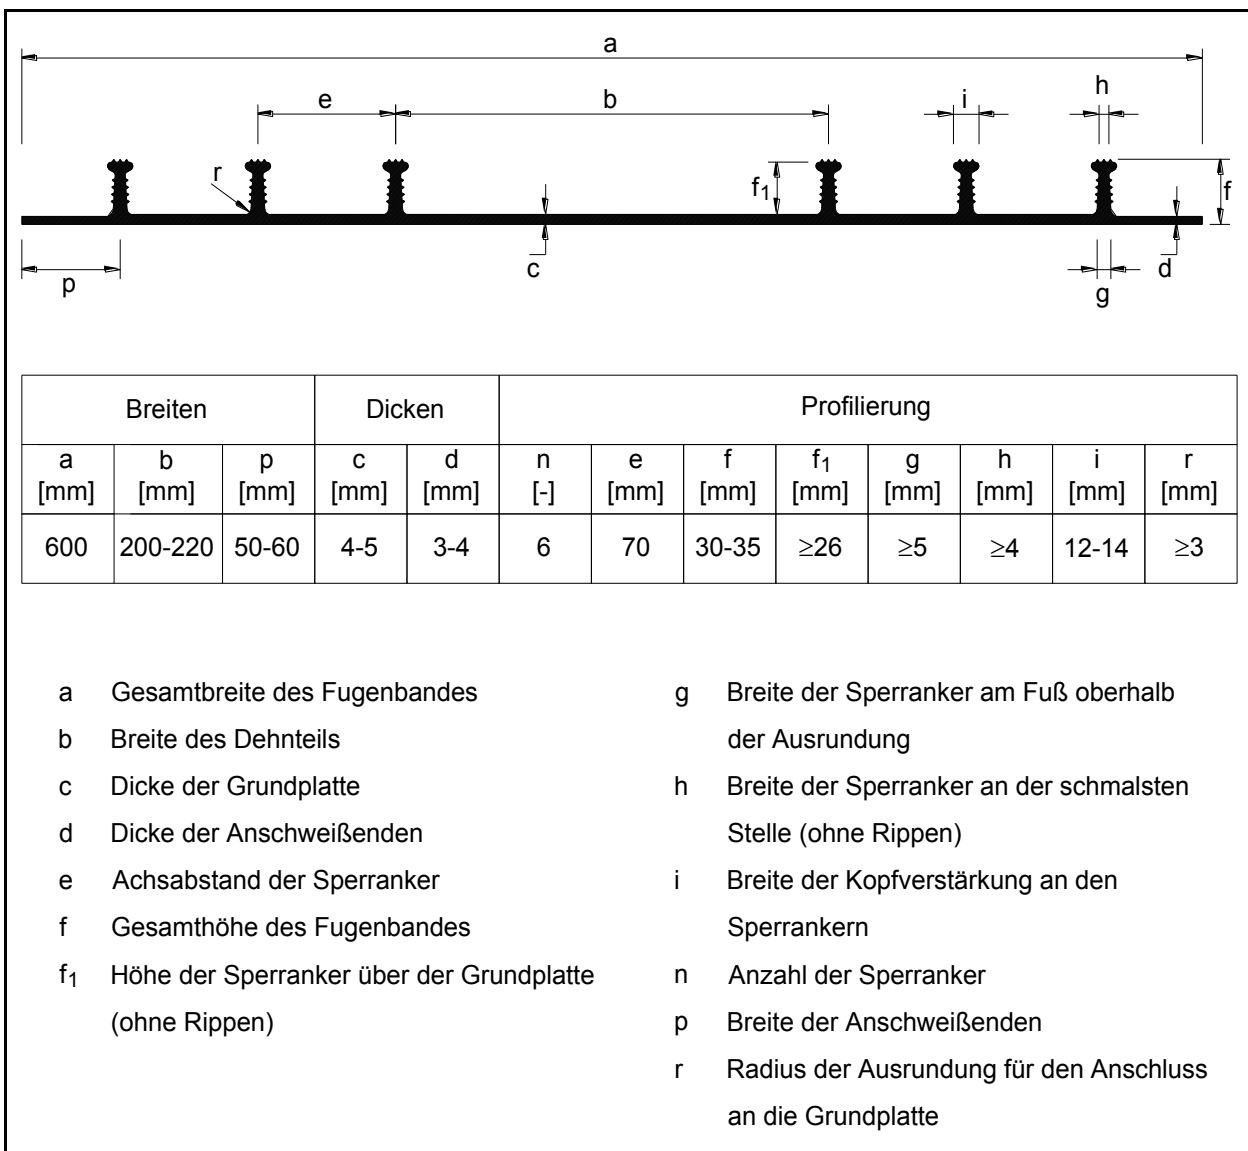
Grundabmessungen Schottfugenband, Tunnel in geschlossener Bauweise
